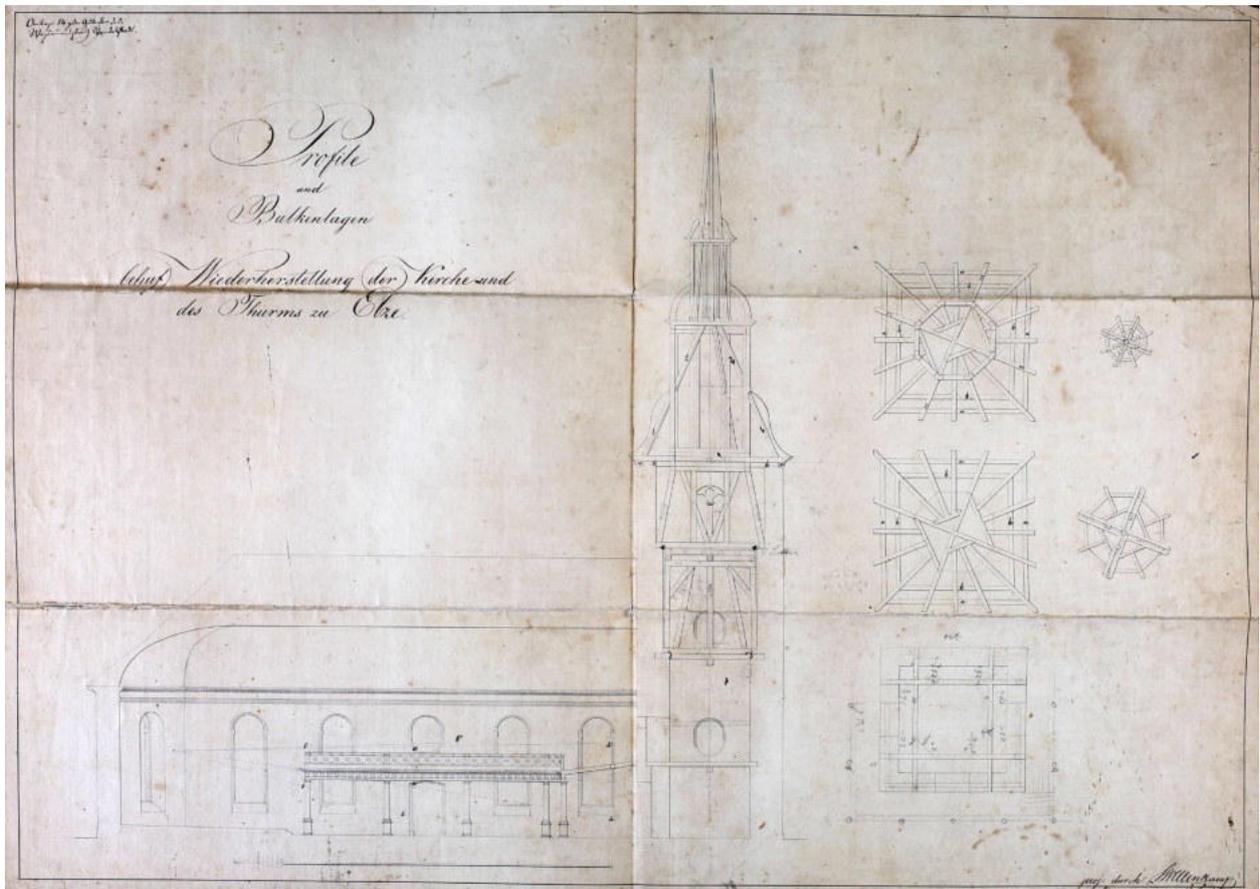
Längsschnitt des Kirchenbaus mit Grundrissen zur Konstruktion des Turmaufbaus; bezeichnet als Anlage 14 zum Gutachten des Wegebaumeisters Wandelstedt (?) mit „Profile und Balkenlagen behuf Wiederherstellung der Kirche und des Thurms zu Elze.“ und „proj. durch Wellenkamp“.
